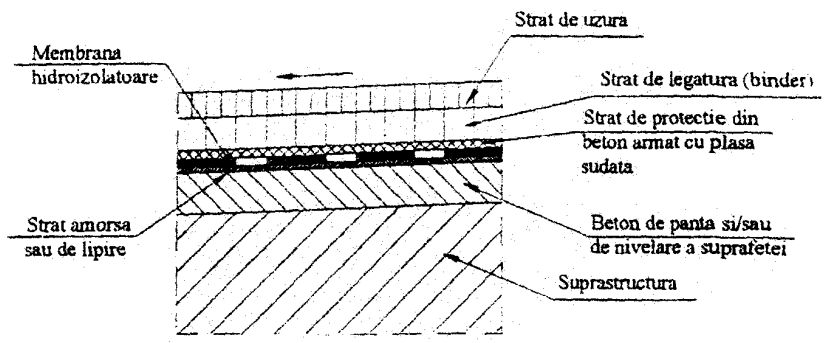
Strat de protectie din beton armat cu plasă sudată
